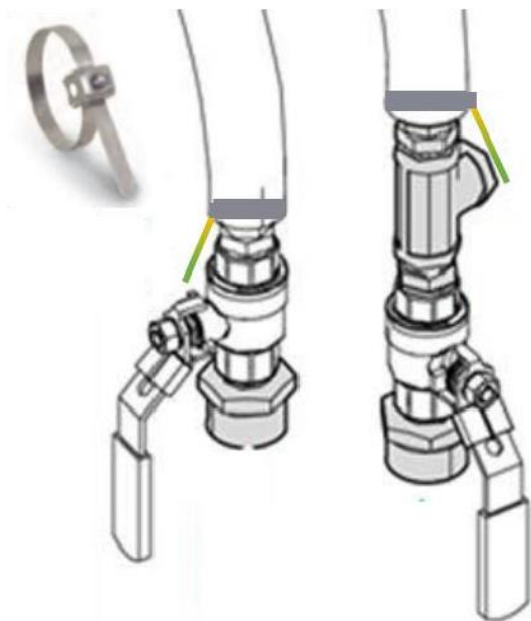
Banderungsschelle Zulauf-/Rücklaufleitung unten
